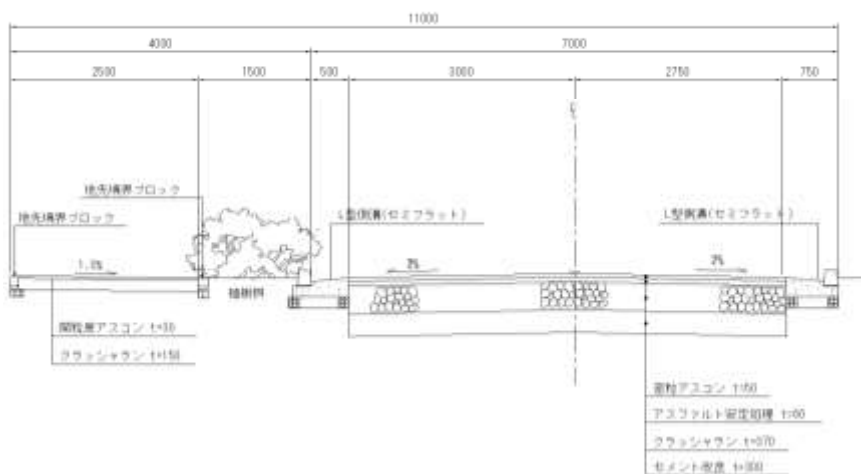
(3) 道路標準断面図（外周準幹線道路）
